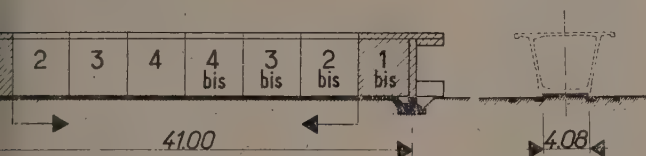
Découpage d'une poutre en huit voussoirs.
